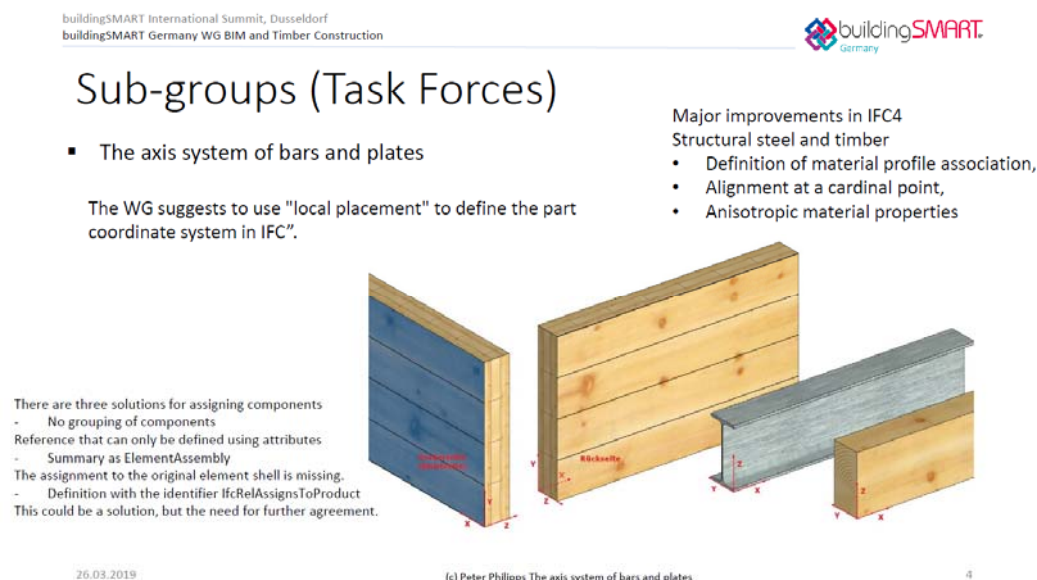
buildingSMART ドイツ支部木造 BIM ワーキンググループ活動内容紹介（抜粋）
